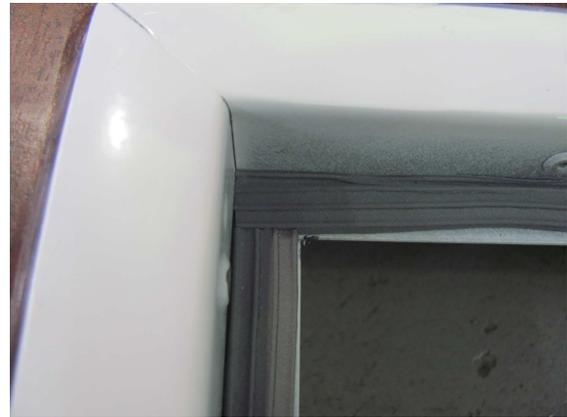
Probekörper 1, Kronendichtung im Außenrahmen
